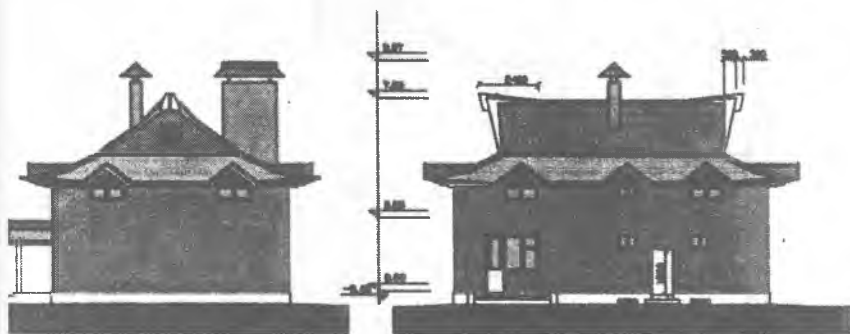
Фасады индивидуального коттеджа, план которого представлен на рис. 8. В цветовом решении и системе перекрытий использованы традиции калмыцкой буддийской архитектуры.
